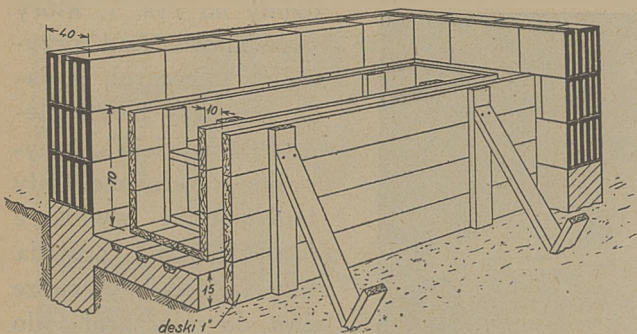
Murowanie ścian z bloków dimabetonowych.
